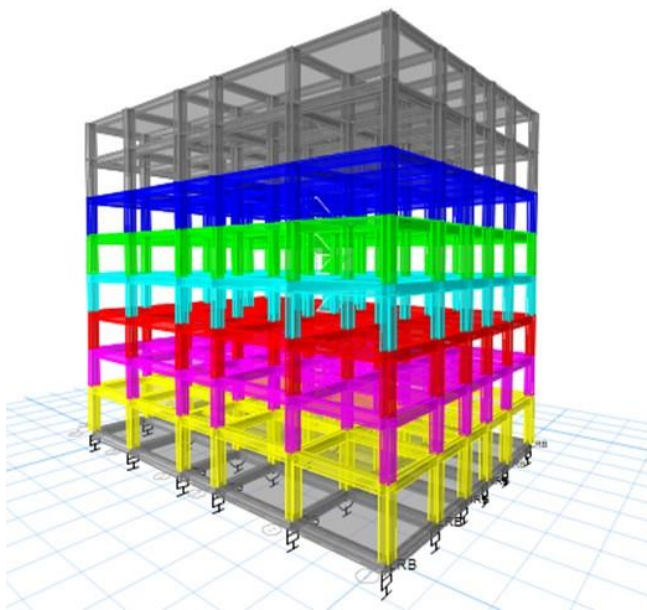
Vista del modelo de elementos finitos de la edificación de sistema estructural PRM y con aislamiento sísmico en la base.
